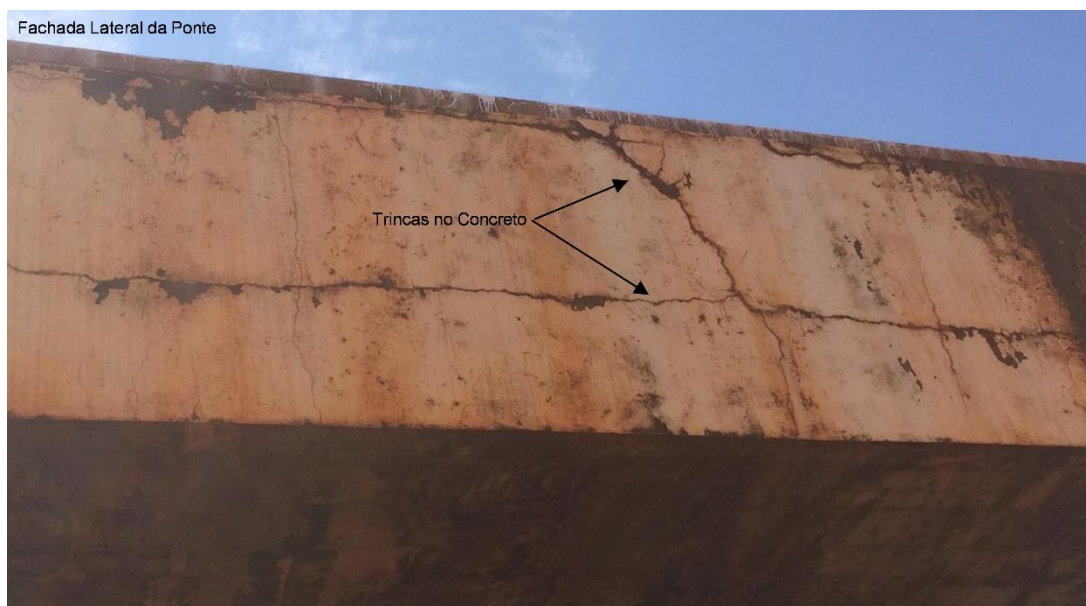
Trincas na Laje de Fundo do Tabuleiro da Ponte. (Observação: Sinais de Resina Epóxi para Preenchimento das Trincas no Passado)
